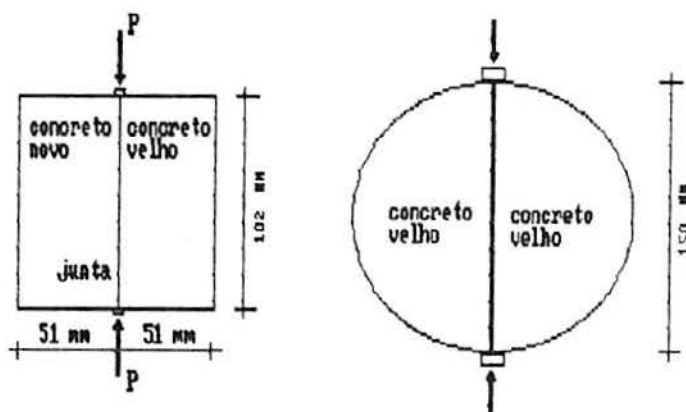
Ensaio de tração indireta (WALL et al.<sup>(112)</sup>)
